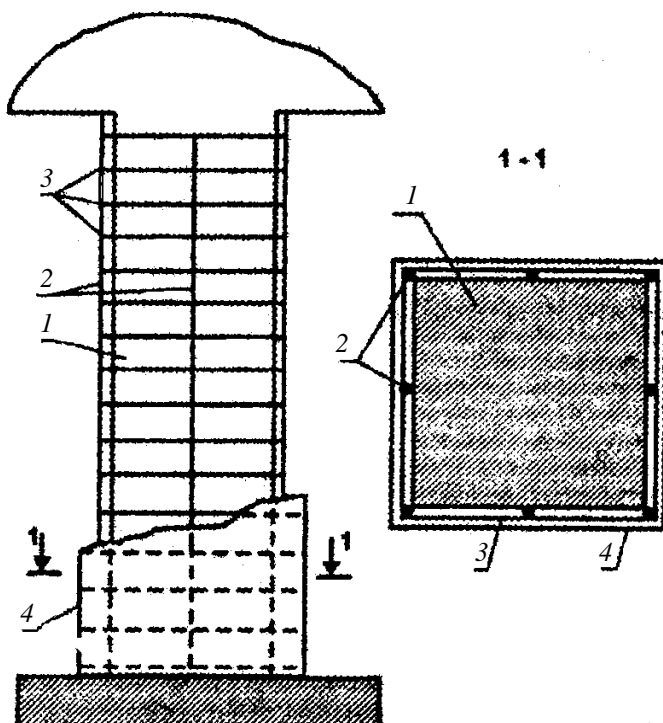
Устройство железобетонной или армированной растворной обоймы: 1 – усиливаемый столб (простенок); 2 – стержни диаметром 6–12 мм; 3 – хомуты диаметром 5–10 мм; 4 – бетон класса С30/37 или раствор марки 75-100
